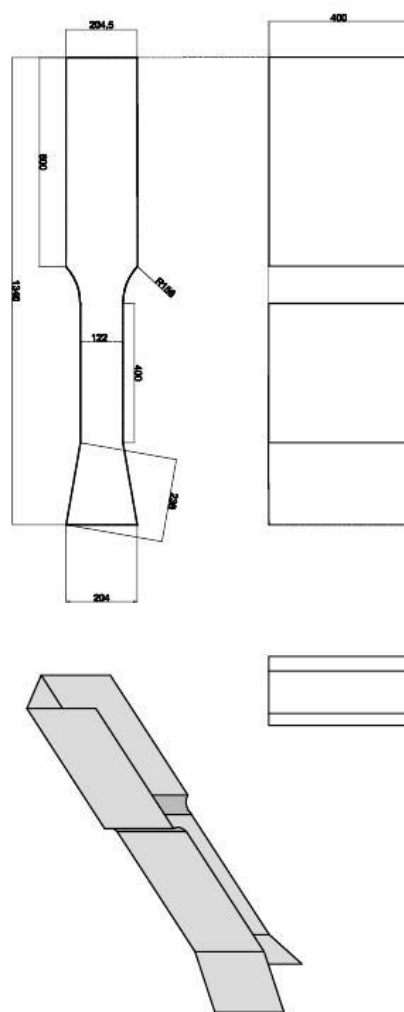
Исполнительный чертеж лотка Вентури для р. Превратный
